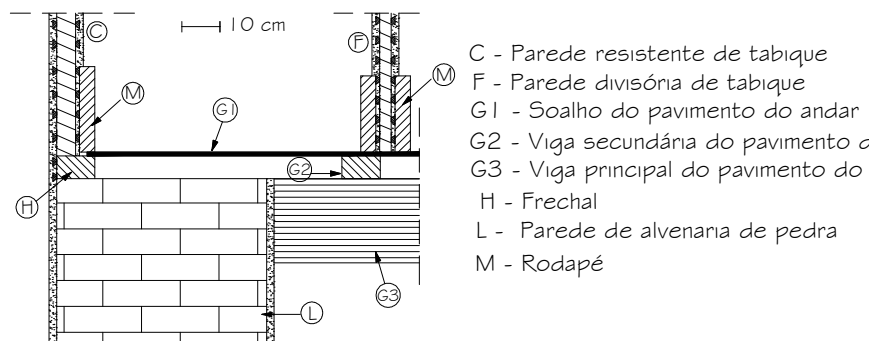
Ligação entre a parede interior de tabique e o pavimento do andar, detalhe VII
